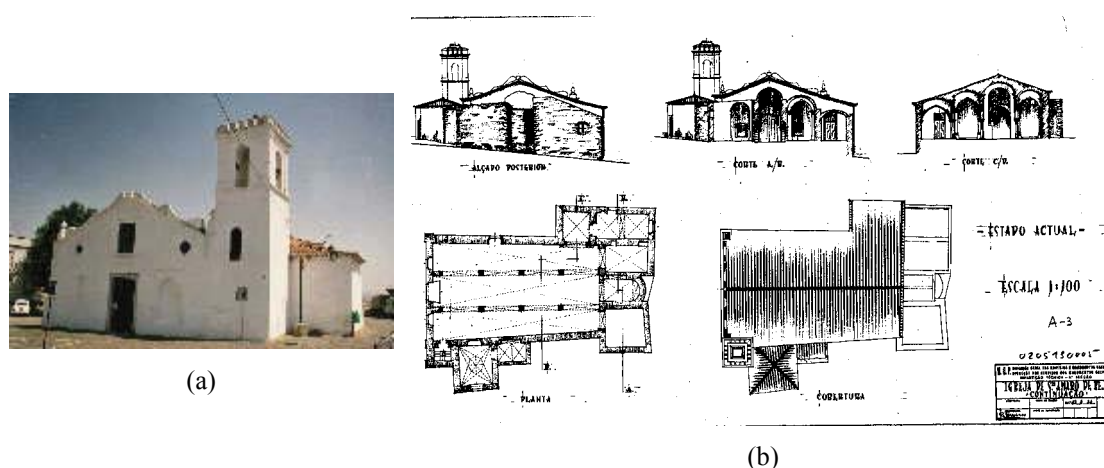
Peças desenhadas [DGEMN]: (a) fotografia da fachada; (b) planta, alçados e cortes.
